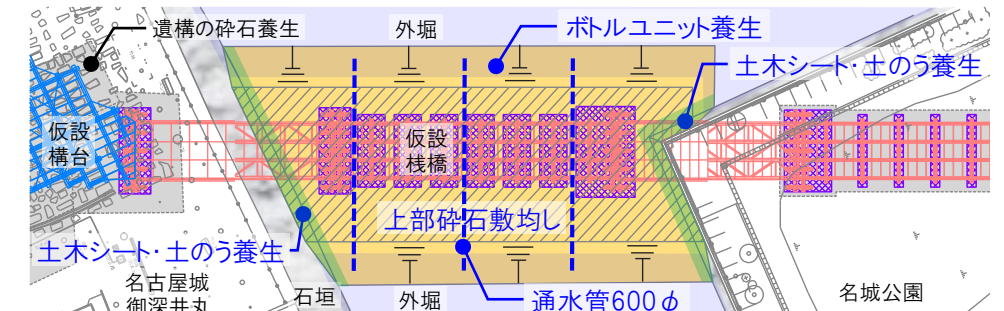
仮設構台とポトルユニットによる外堀養生(平面図)
